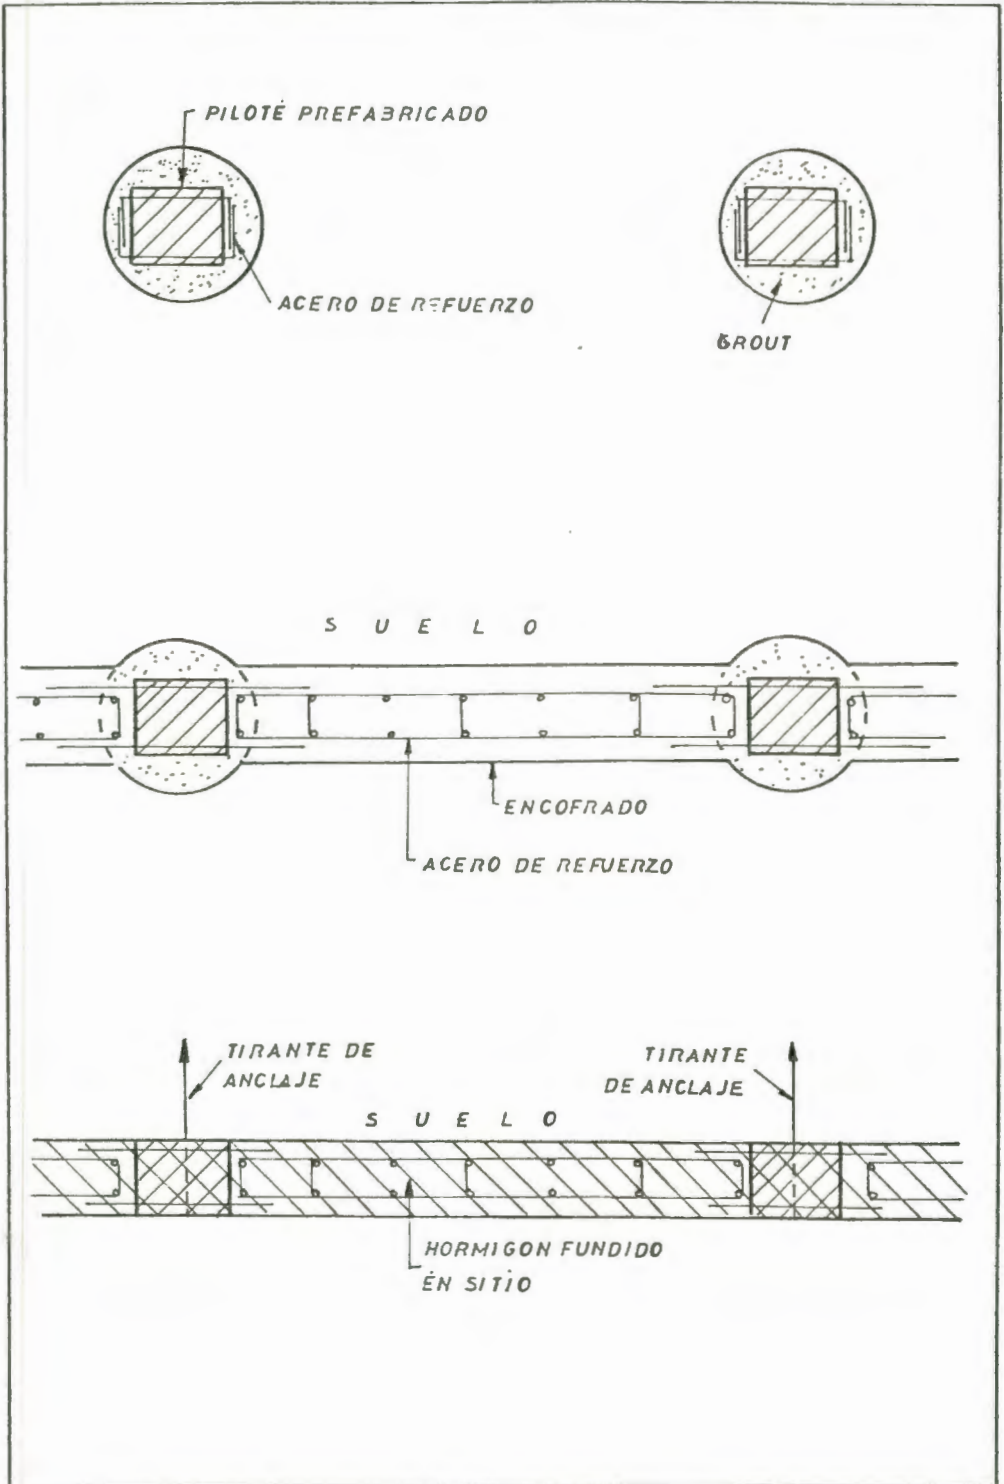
Pilotes de Hormigón Prefabricado y Pared de Hormigón Armado fundido en sitio.
